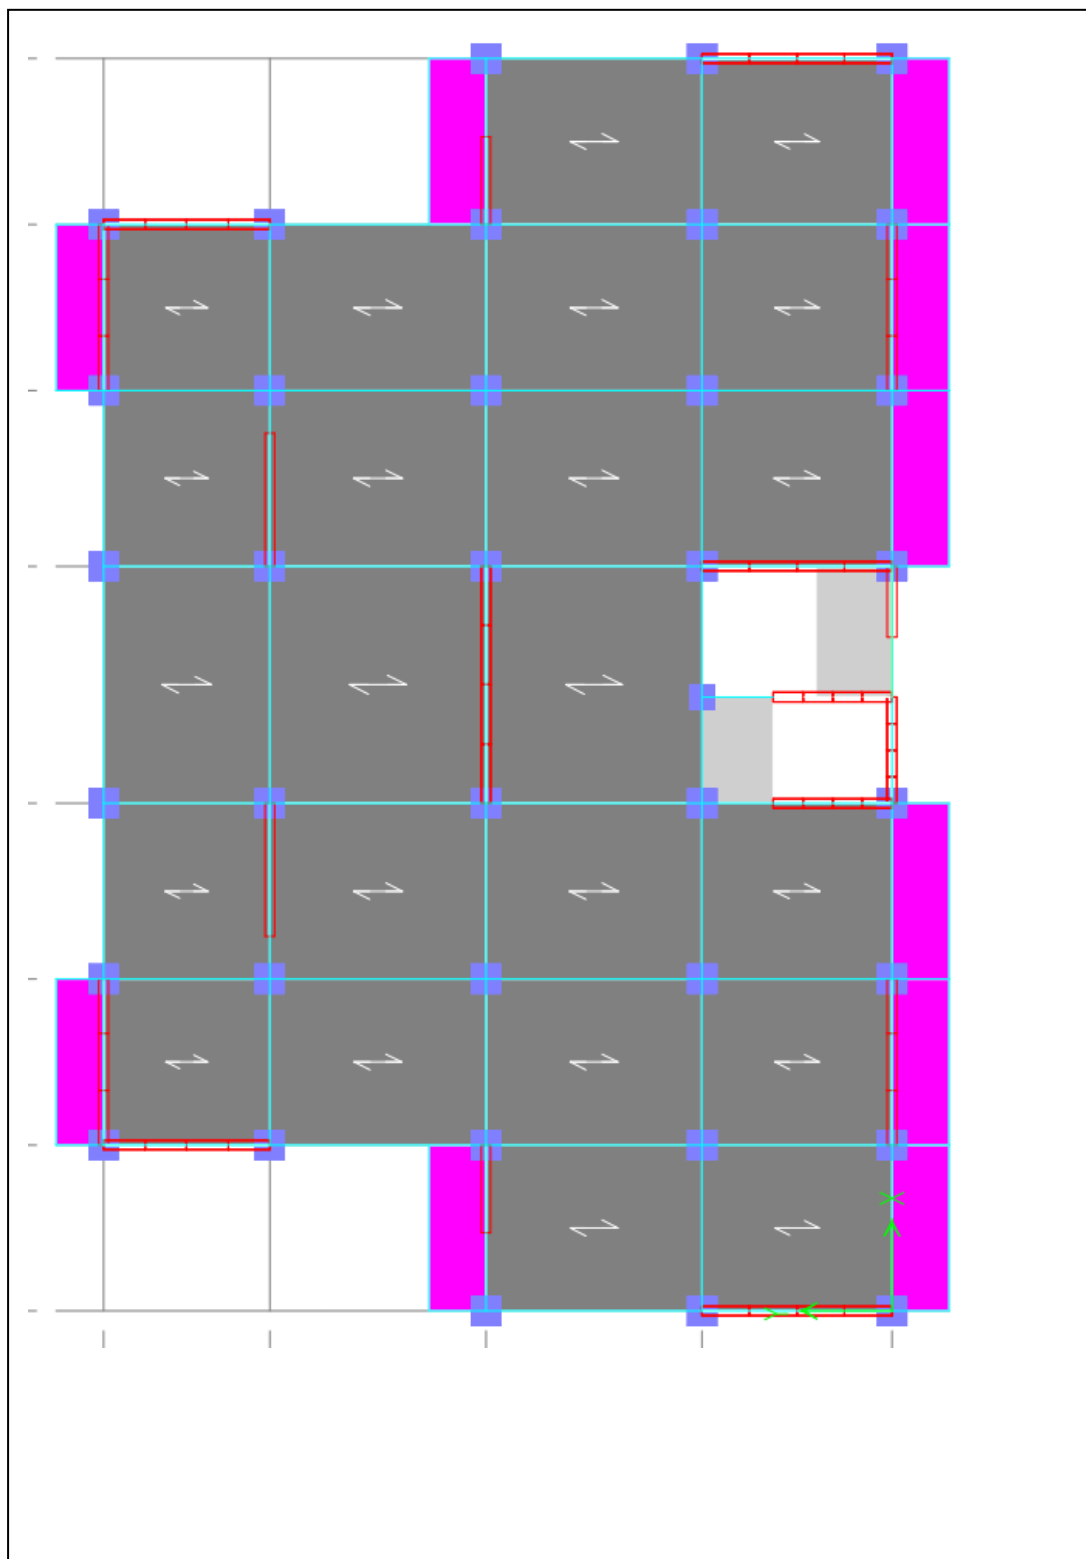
Vue en plan de RDC et des 9 étages de la structure.
